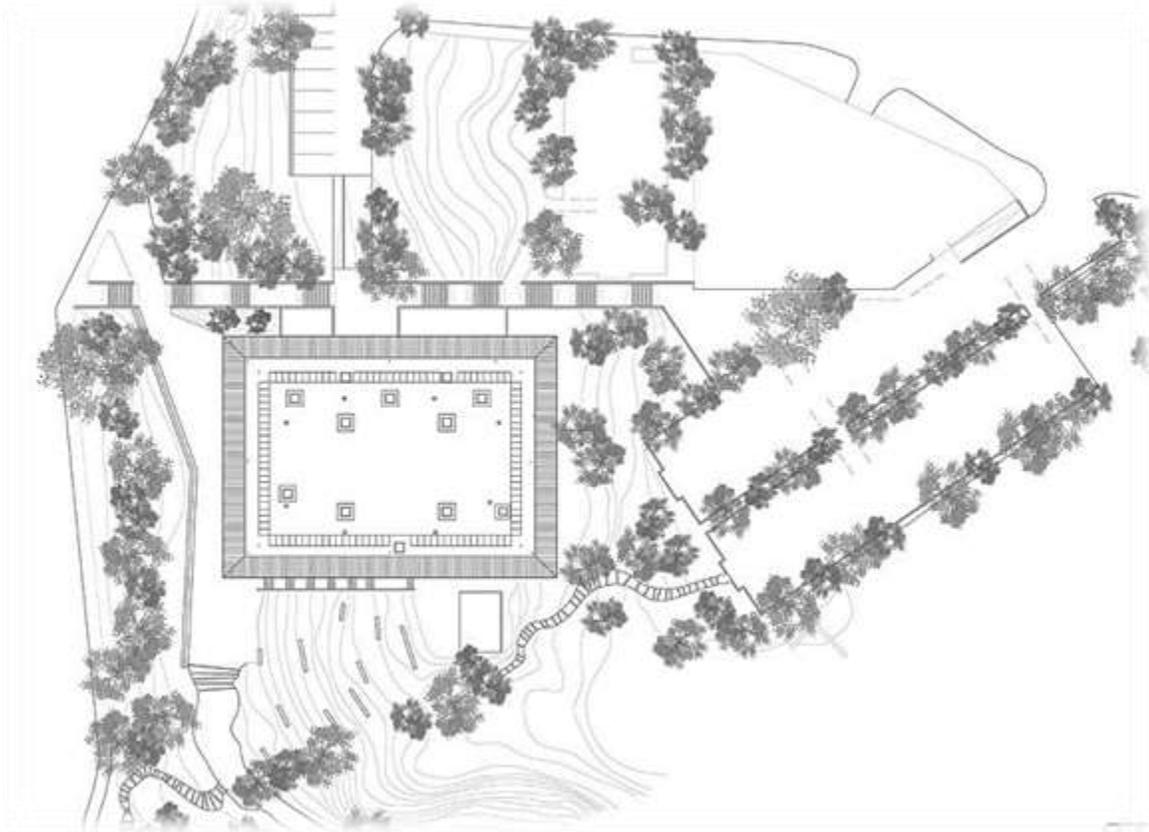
Planta Arquitectónico de Conjunto. Fuente: Hervé de Chastenot
